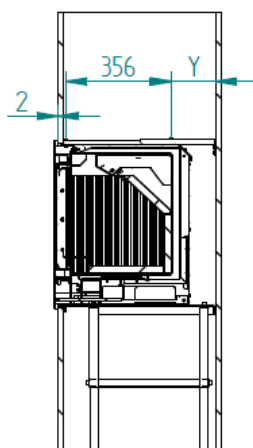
Distância mínima do aro á face do pladur ou alvenaria
